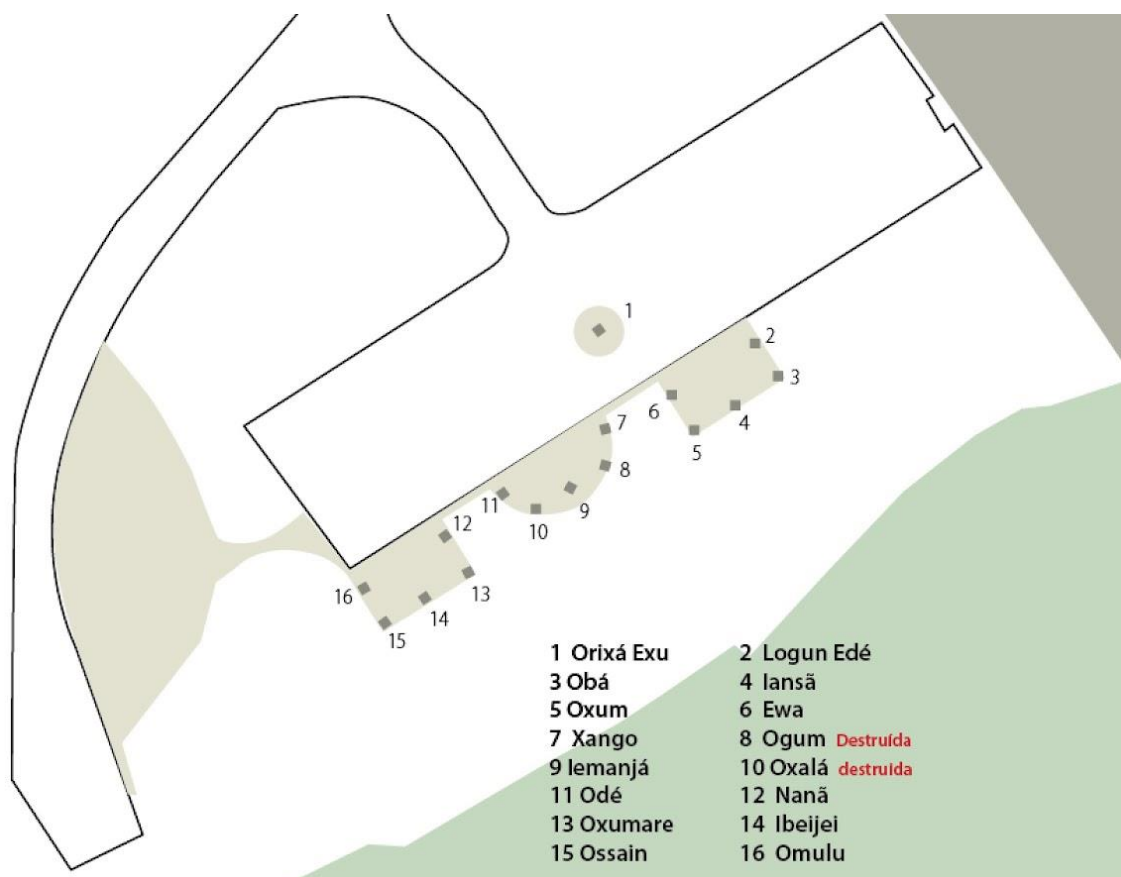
B – Planta da Praça dos Orixás. Fonte: SILVA FILHO, A. R.
